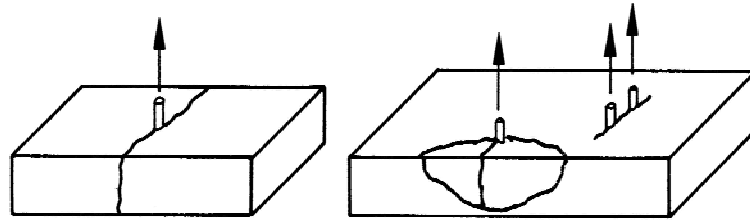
Bruchart Spalten des Betons bei Zugbeanspruchung (Eligehausen/Mallée (2000))
